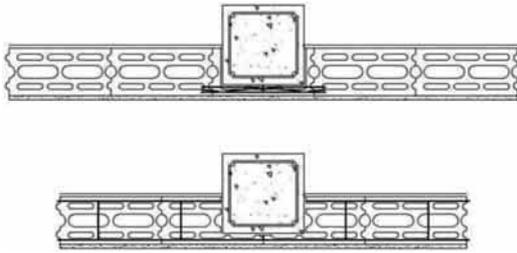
Planta de encuentros de muro de 1 hoja multicámara de cerramiento con pilares en el paño: hiladas pares con anclajes, hiladas impares con retículas de tendel.
